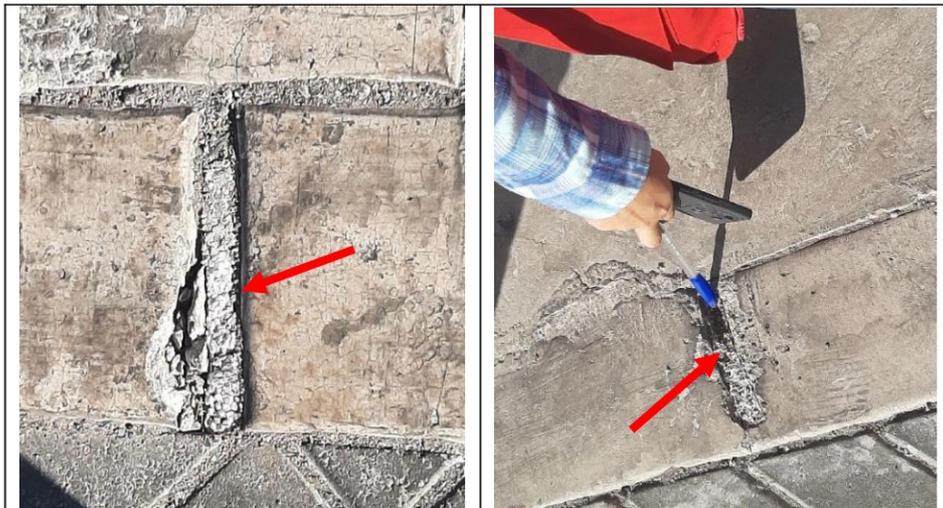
Junta de dilatación cubierto de concreto, en sardinel sumergido, avenida Ramón Castilla.
